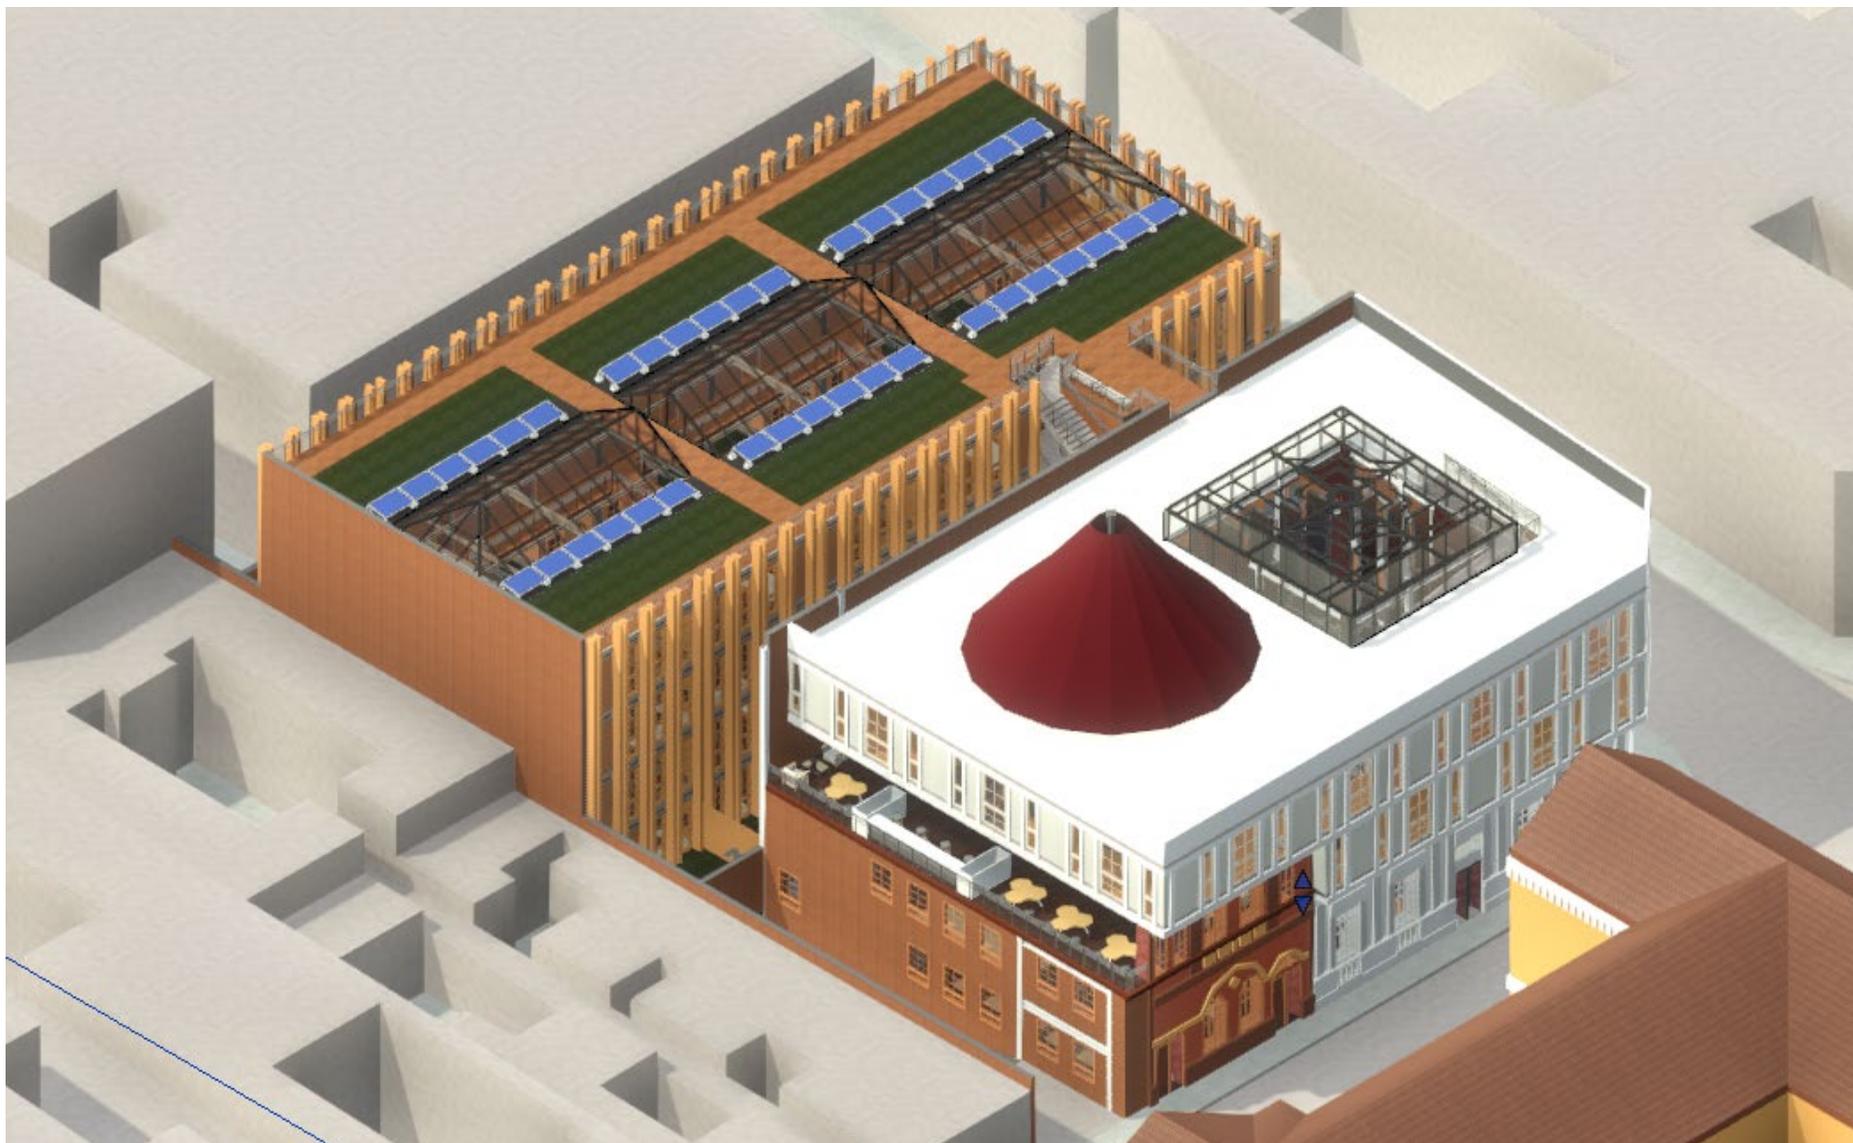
Render 3D, Propuesta Arquitectónica, “Espacio Compañía.”
